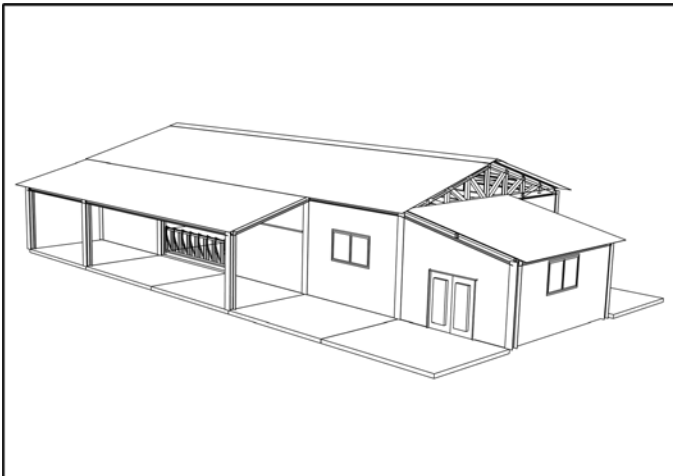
vue en perspective (façade principale) – étable longitudinale pour 5 vaches laitières.
